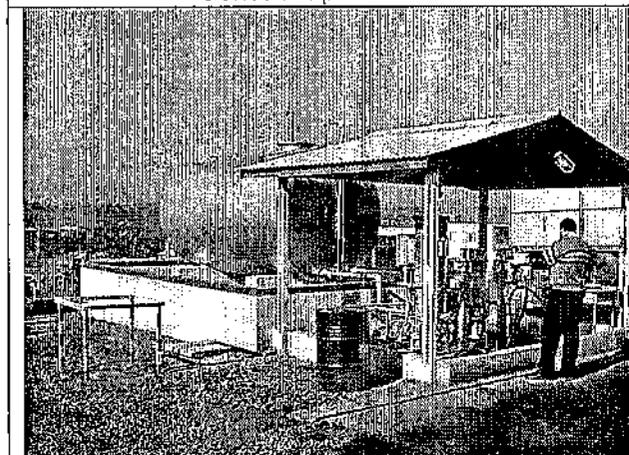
Tanque de combustível em operação no canteiro da Const. Queiroz Galvão – Lote 27
